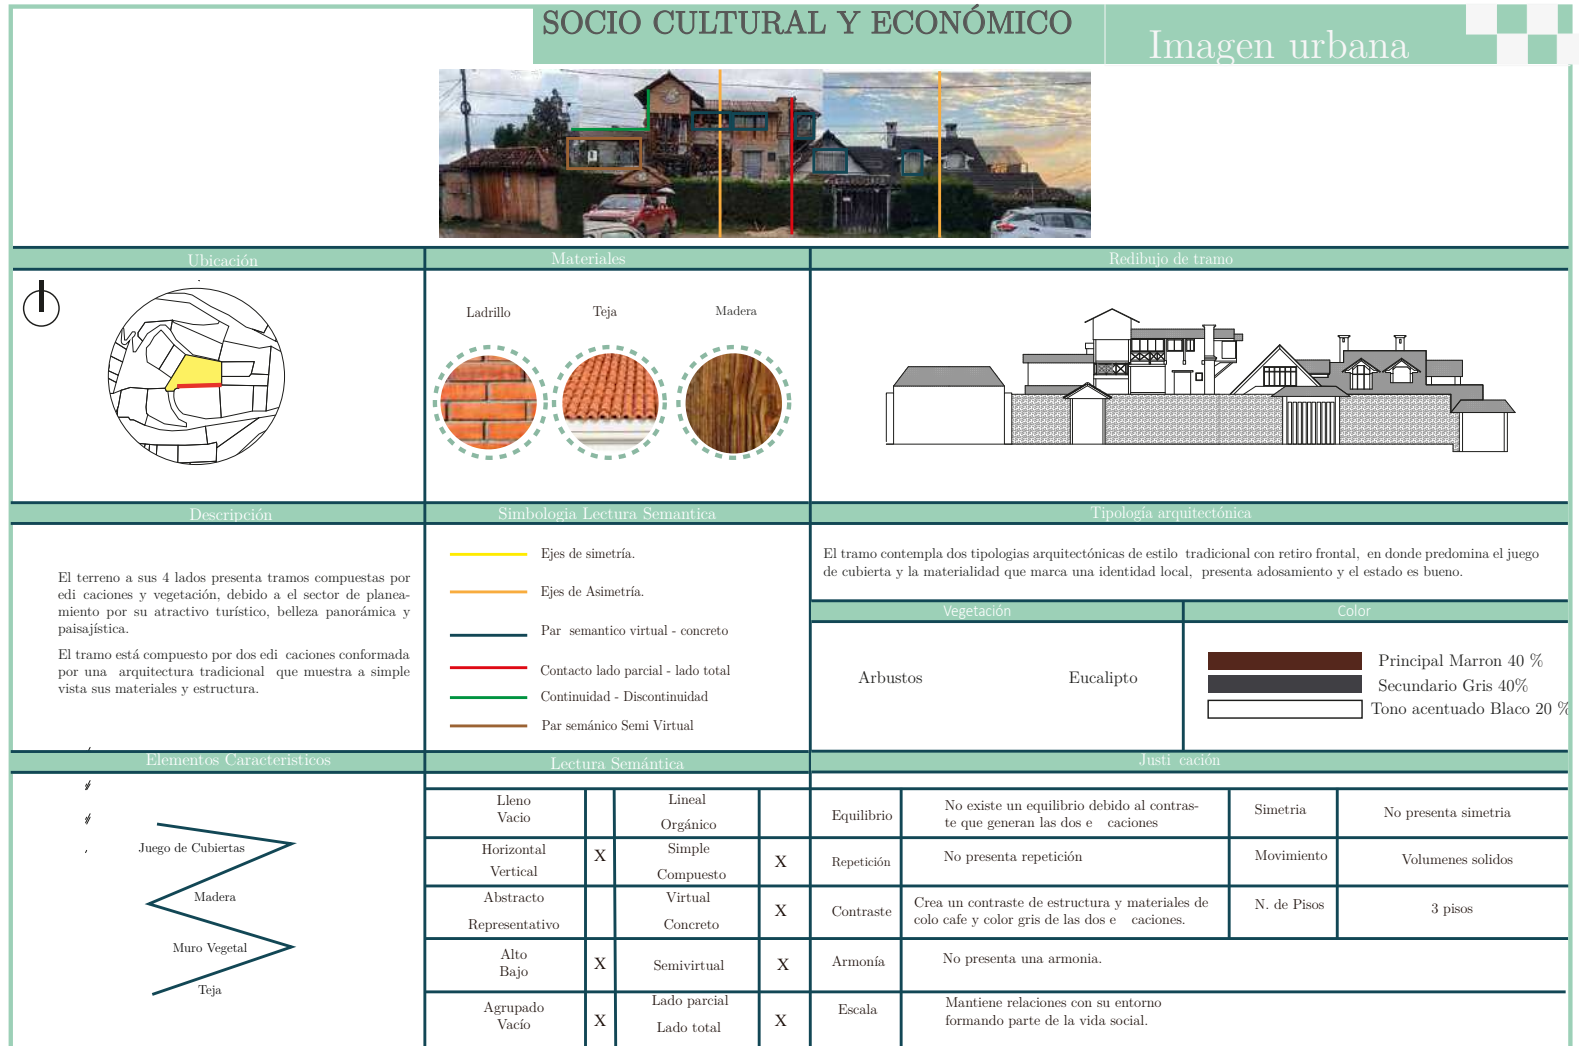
Levantamiento de la imagen urbana sur por tramo. Fuente y elaboración: Propia.
